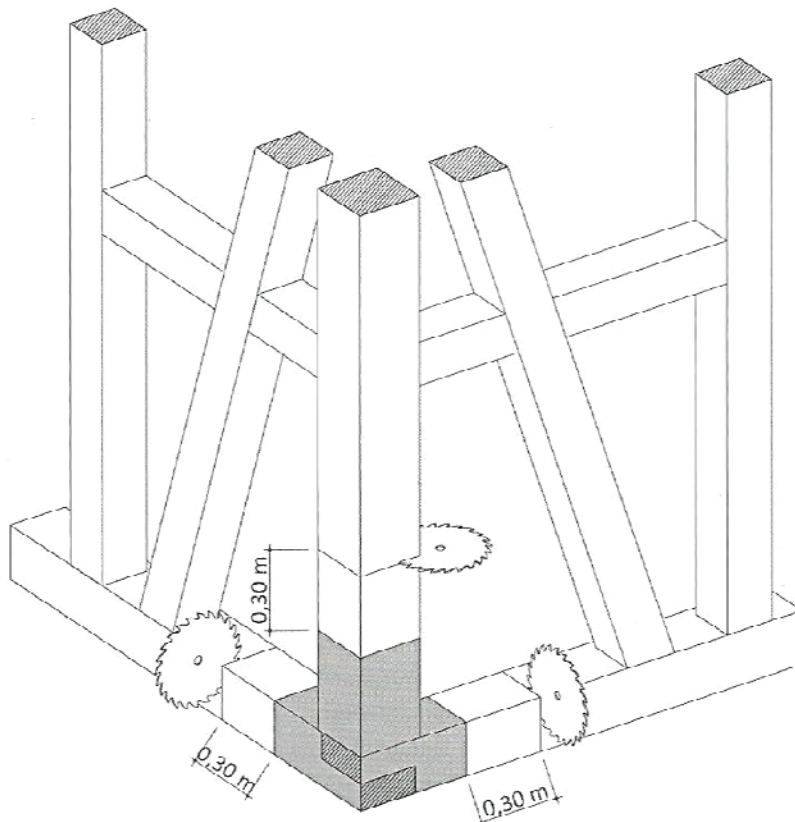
Darstellung des Mindest-Sicherheitsabstandes von 0,30 m für den erforderlichen Rückschnitt bei Holzbauteilen ohne ausreichenden Restquerschnitt. Dunkel gekennzeichnet ist der mit bloßem Auge erkennbare Befall durch einen Nassfäulepilz.
